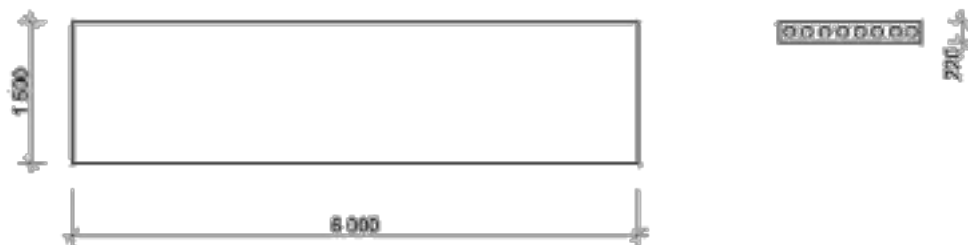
Габаритные размеры пустотной плиты перекрытия
